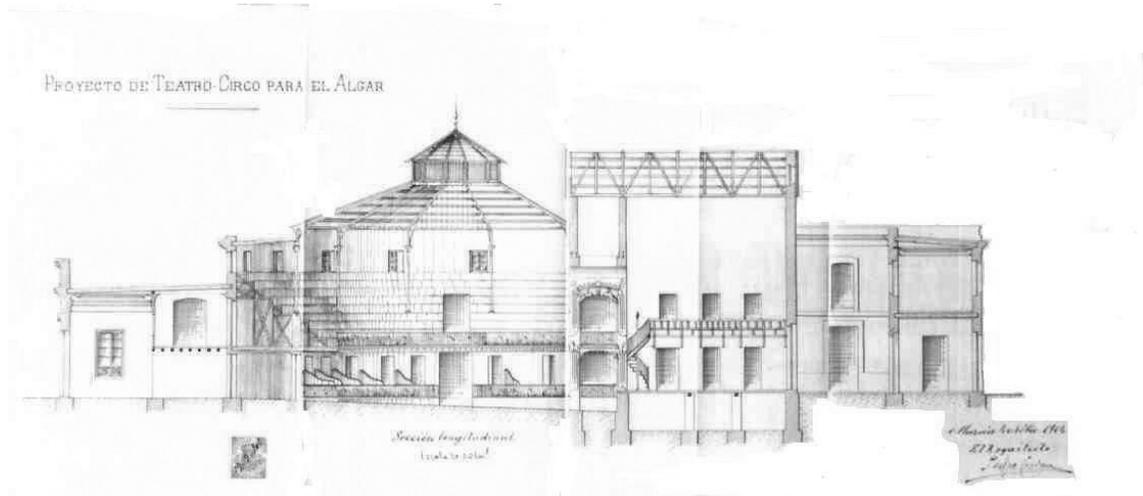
Plano original de sección del proyecto redactado por el Arquitecto Pedro Cerdán, para la construcción del Teatro Circo de El Algar.
